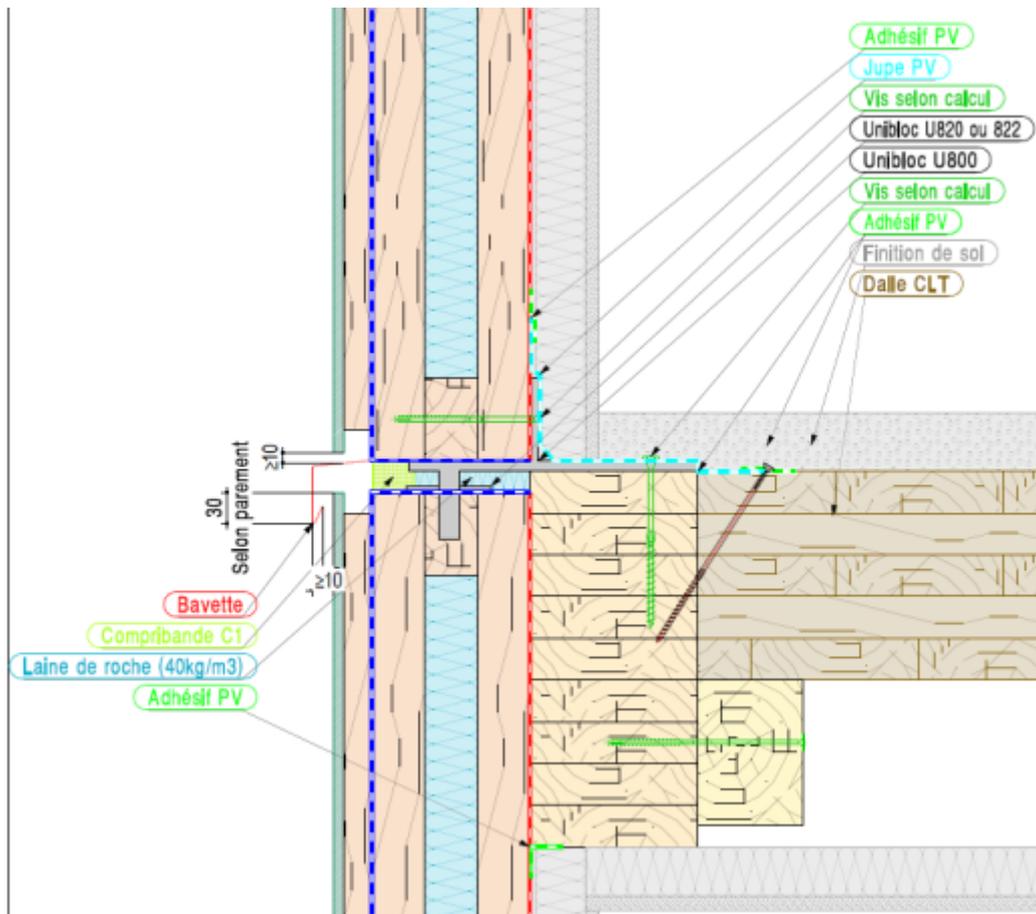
Raccord de panneaux sur poutre de rive bois et plancher bois avec chape liquide
